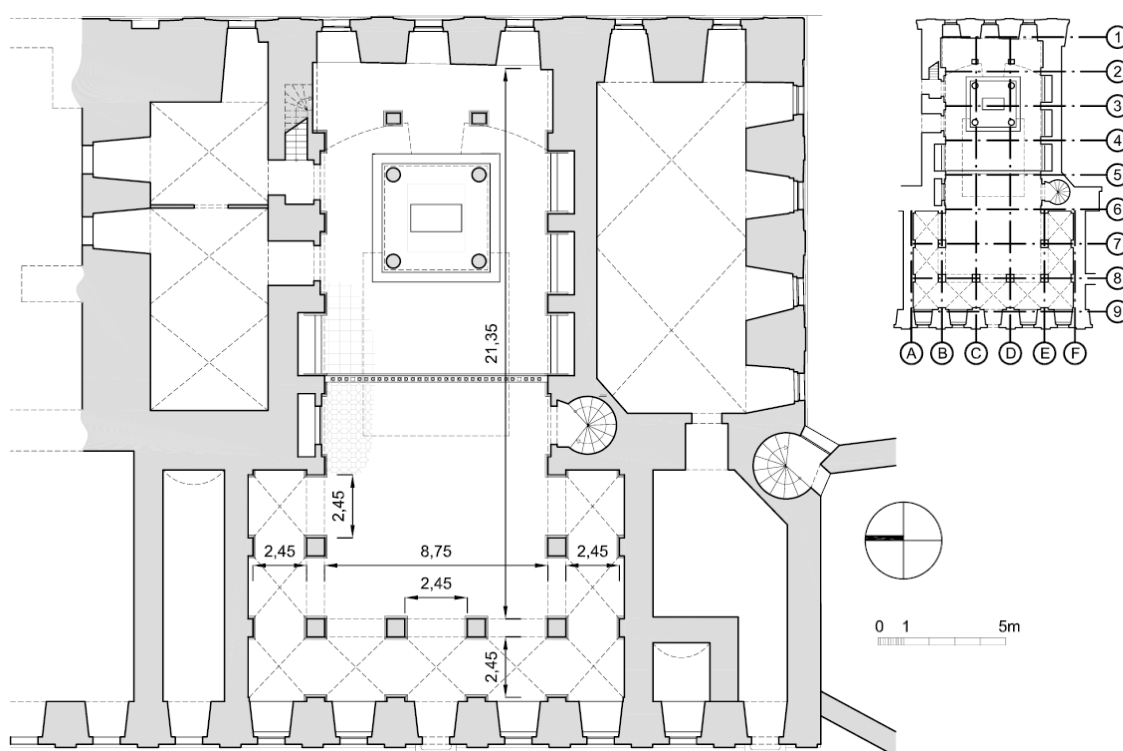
Rekonstruktion, Grundriss Erdgeschoss, in Anlehnung an [Sch 04/1]
